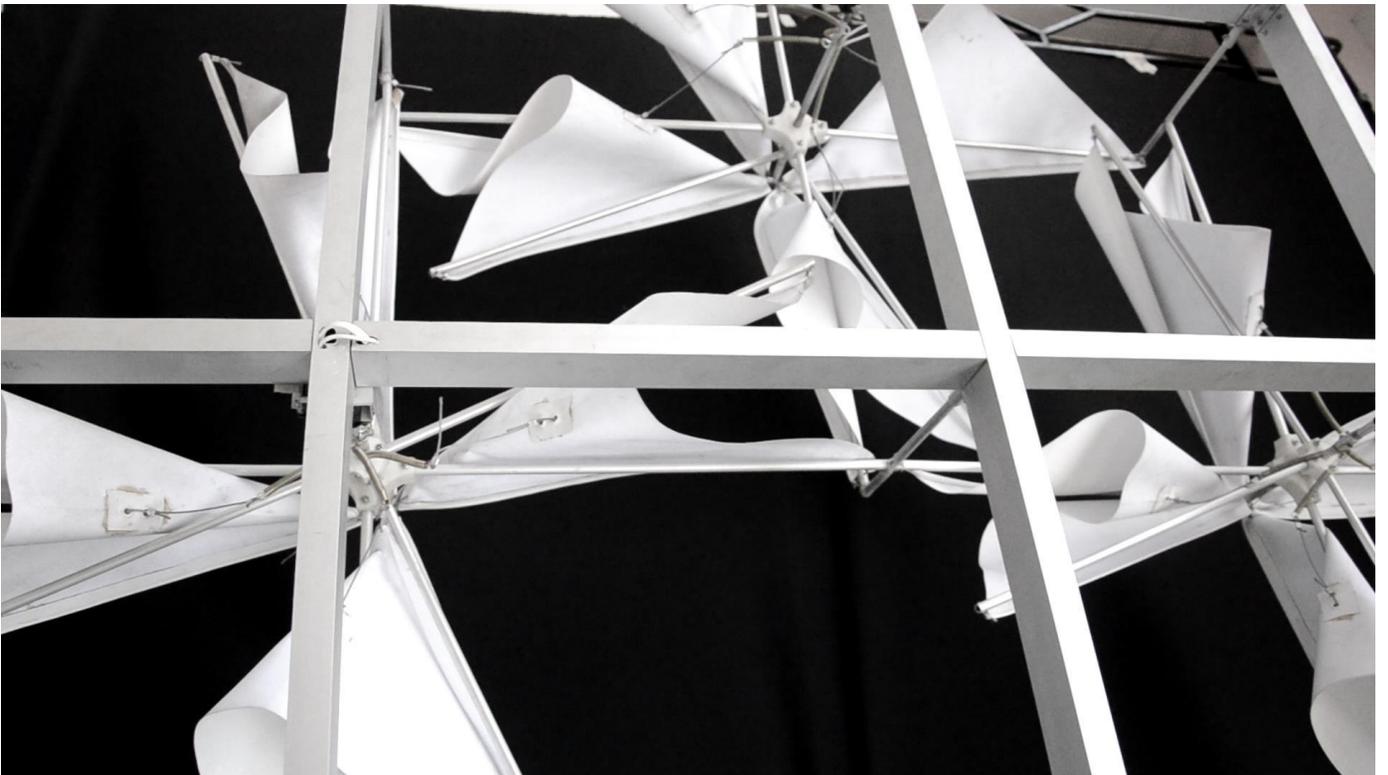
Elevación del modelo escala 1/2 de la fachada dinámica cerrada.
